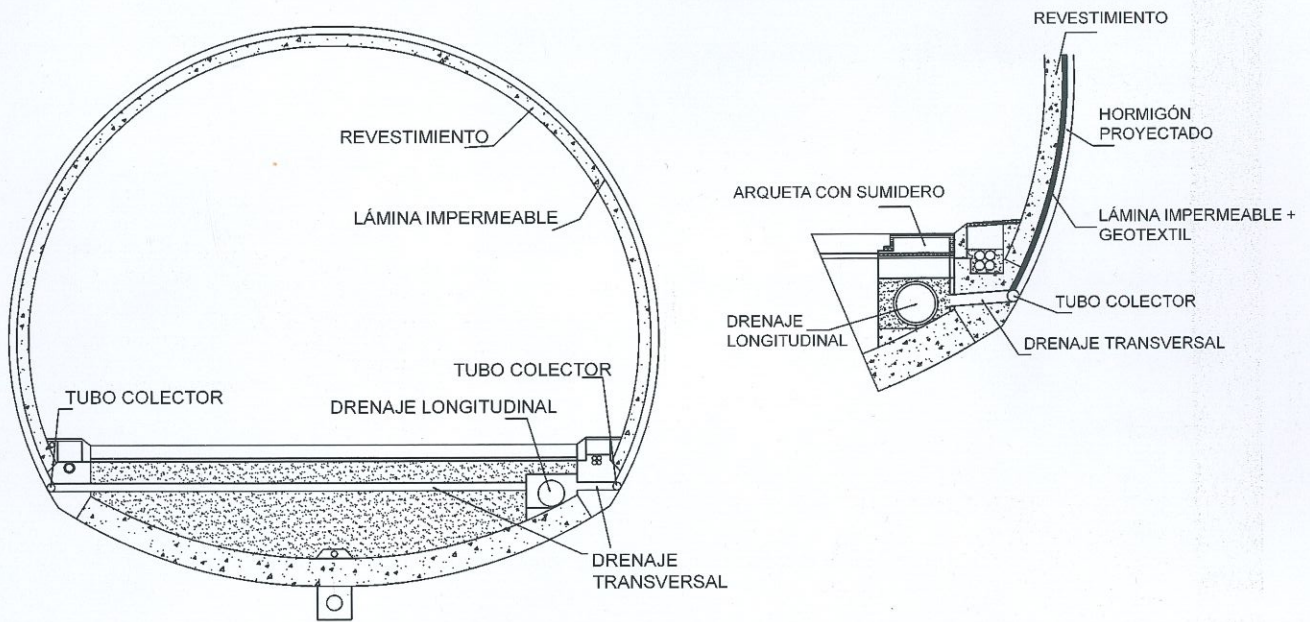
Secciones clásicas de impermeabilización y drenaje de un túnel.
